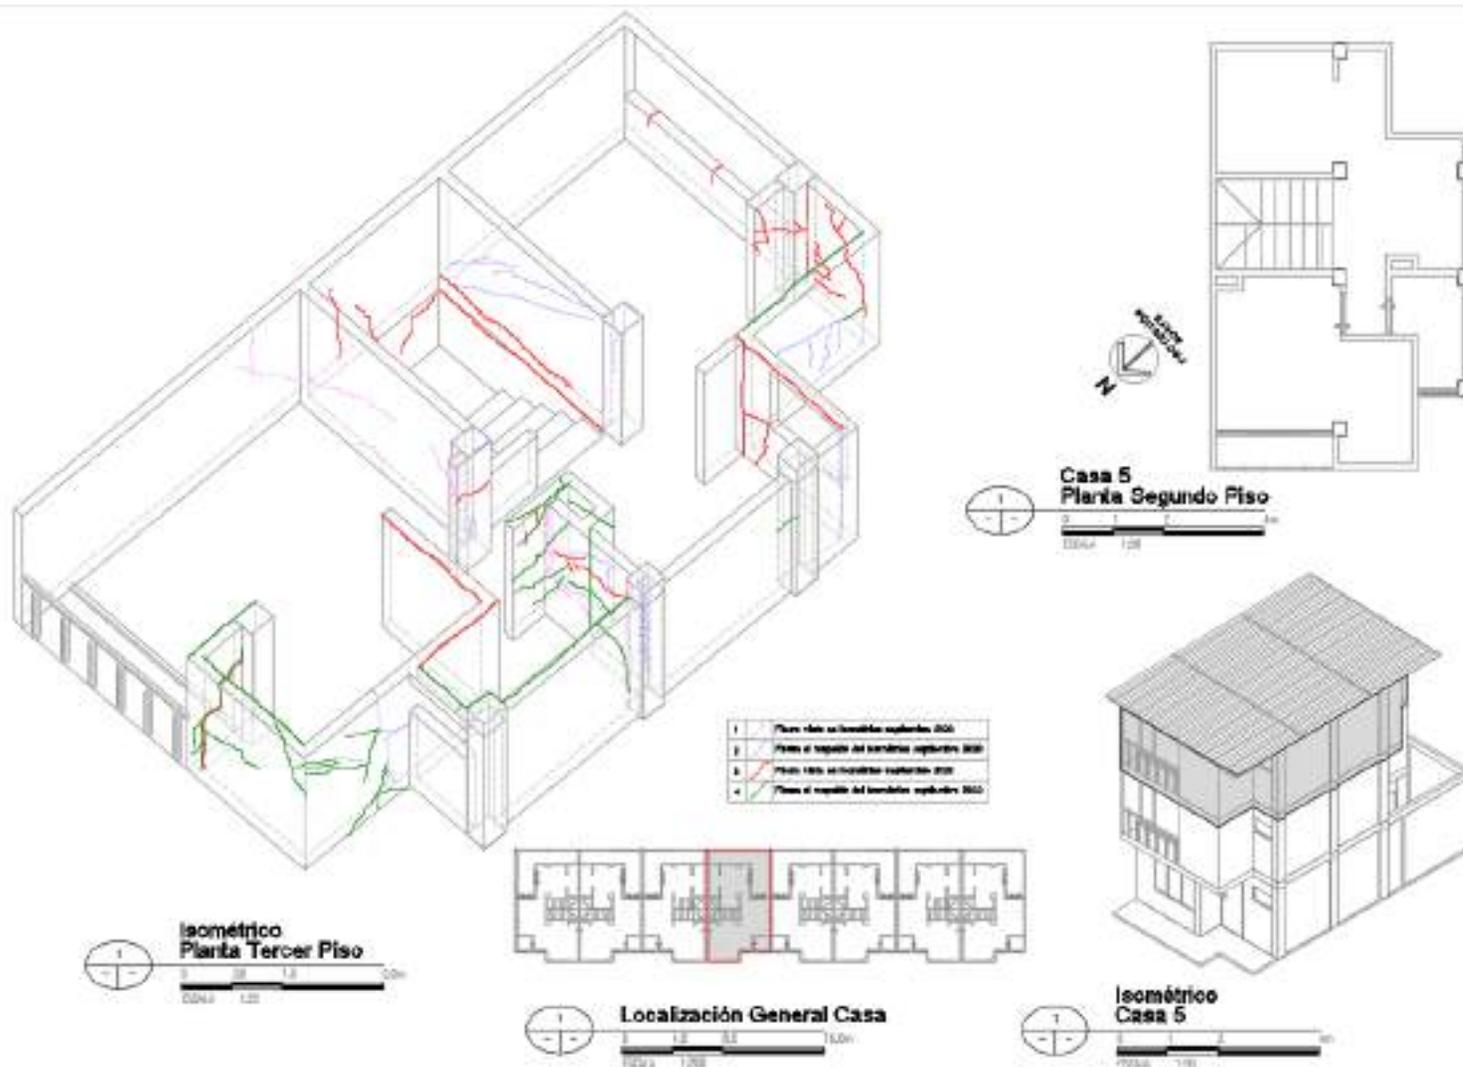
Levantamiento de daños tercer piso Casa No. 5.
